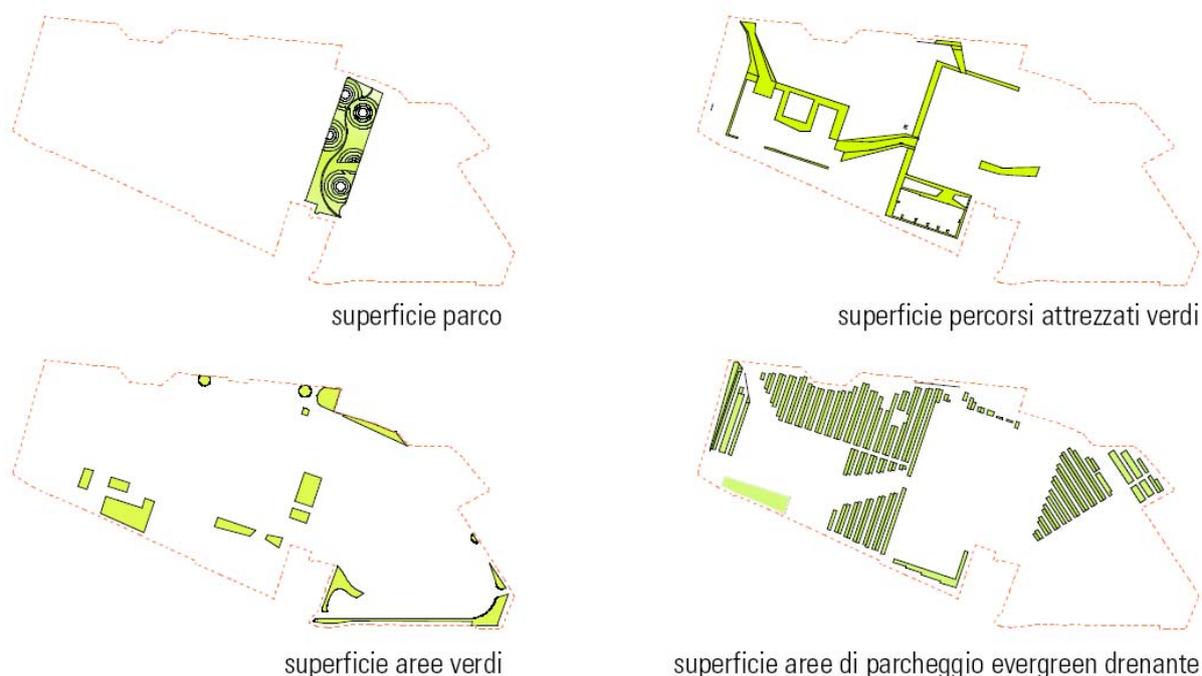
Sistemazione del verde (Stralcio elaborato 5.20 Contratto d'area Torrese-Stabiese)
